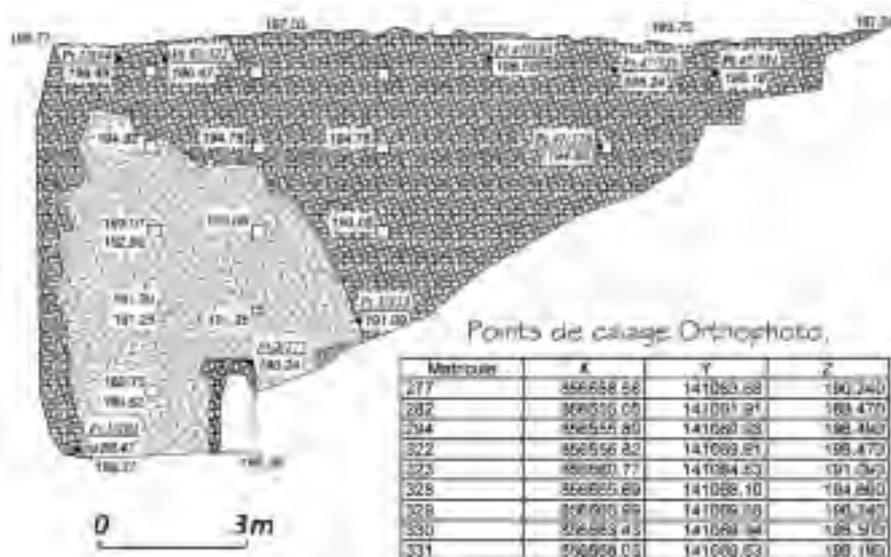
Aqueduc romain. Ouvrage sur la Cause. Structure aval (ouest) profil nord. Plan de façade (St. Michel / SCP).
